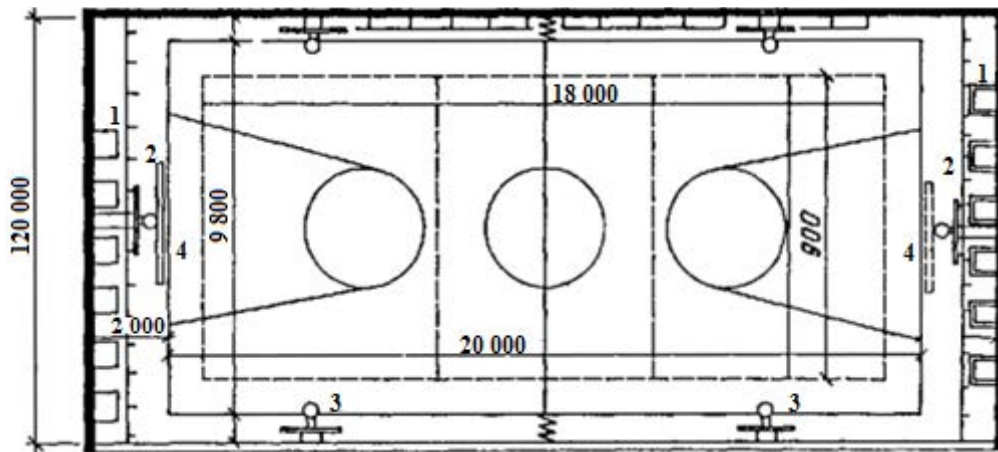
Варіант розташування обладнання в залі фізичної підготовки
